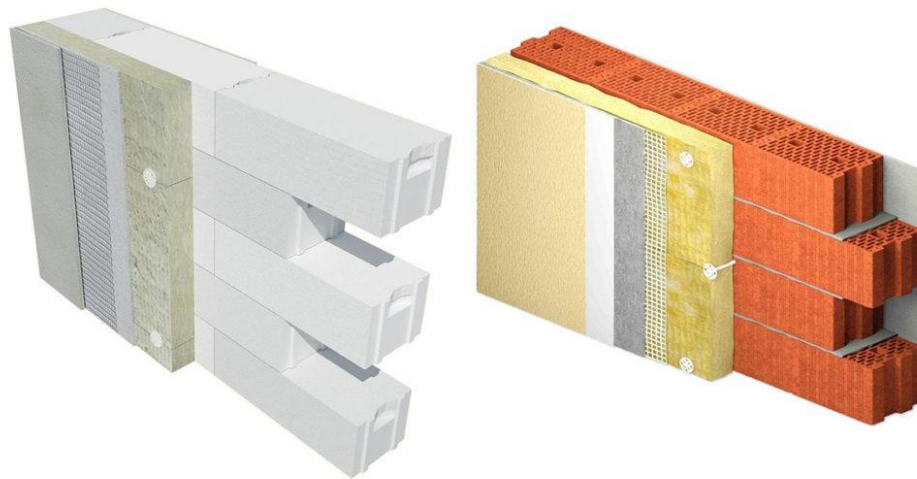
Рекомендації щодо утеплення будинків із газобетону [2]
